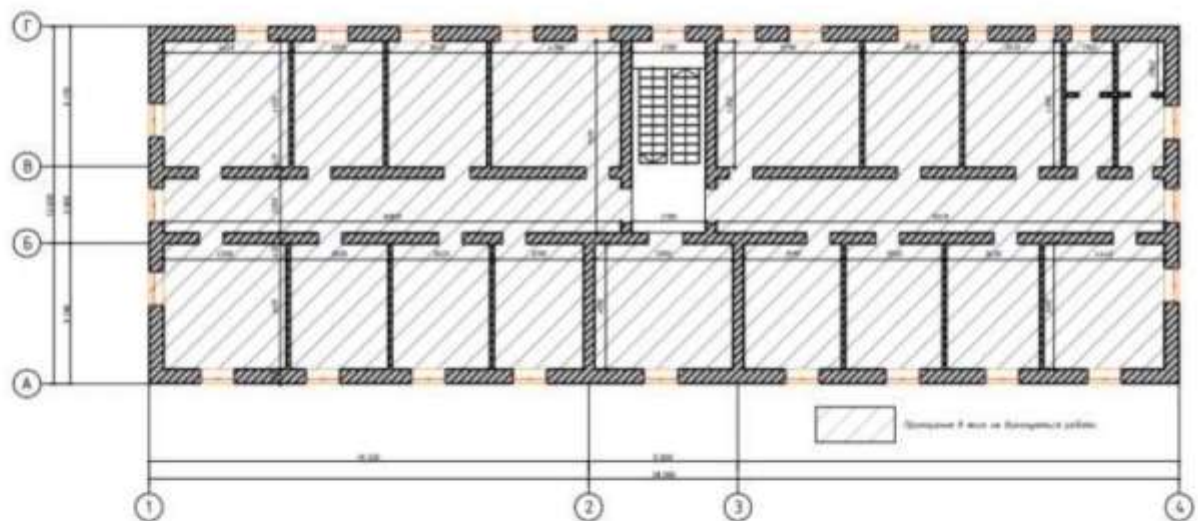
Схема розміщення приміщень 2-го поверху обстежуваної будівлі
